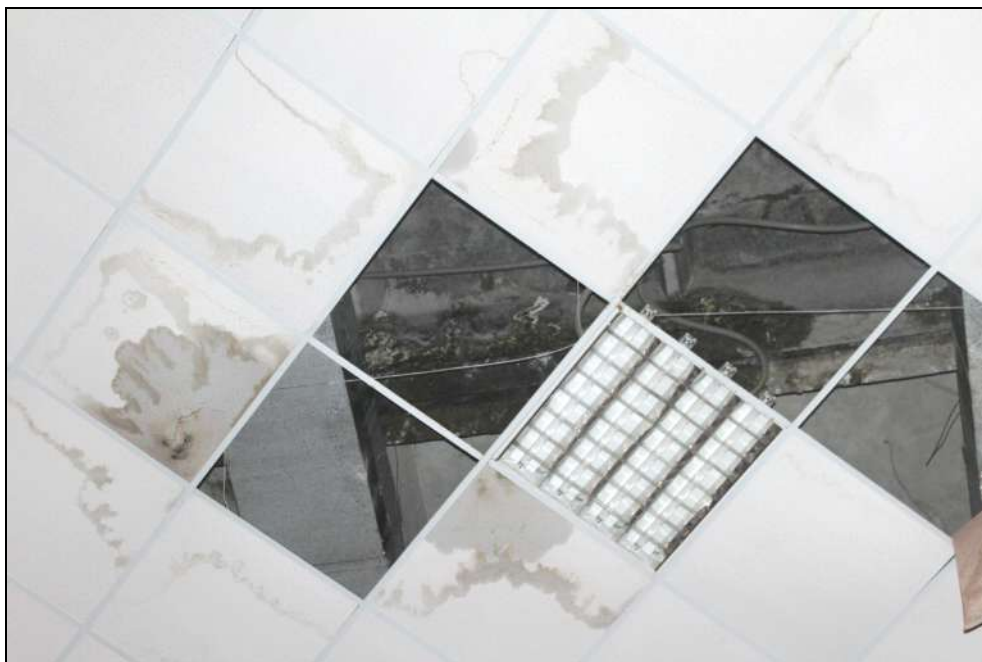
Местное повреждение защитного слоя бетона, фильтрация влаги на площади > 40% покрытия здания.
